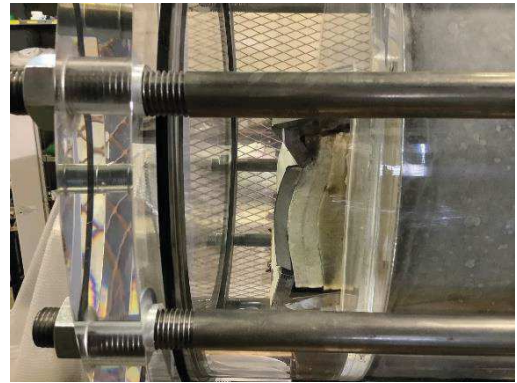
(7) ウレタンシリコン目地変形試験状況 (試験体 No. 8, 伸び 6mm, せん断 30mm)
